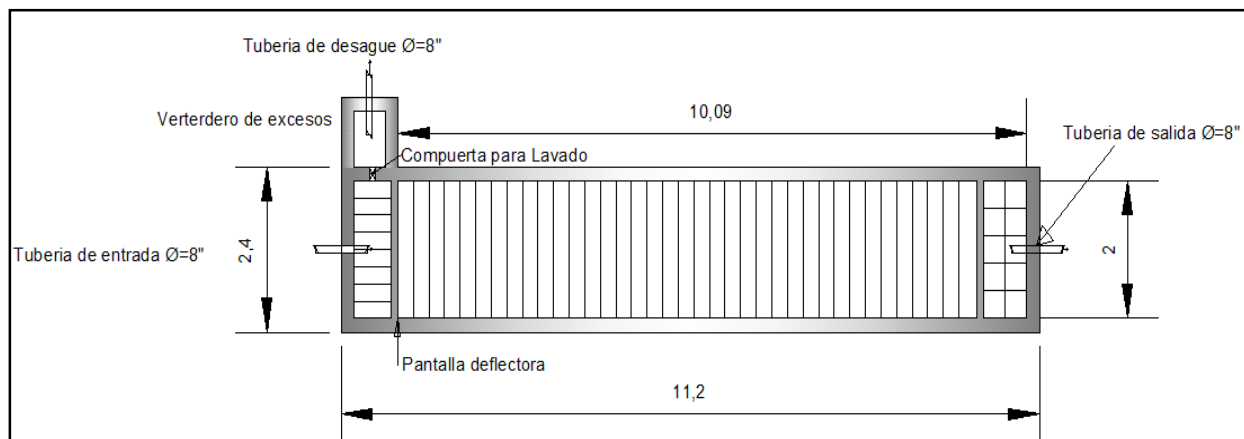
Vista en planta del desarenador ancho útil (2X10).
